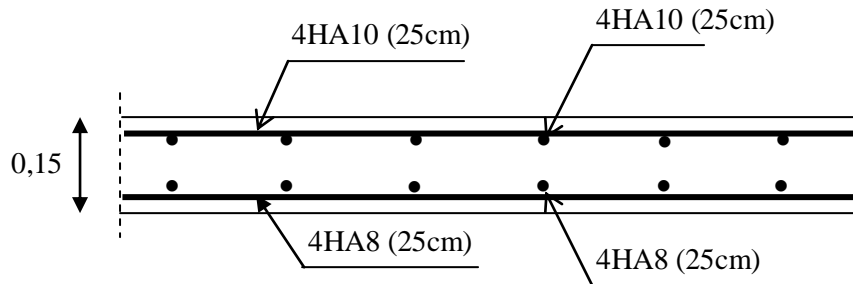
Plan de ferrailage de la dalle pleine de la salle machine
